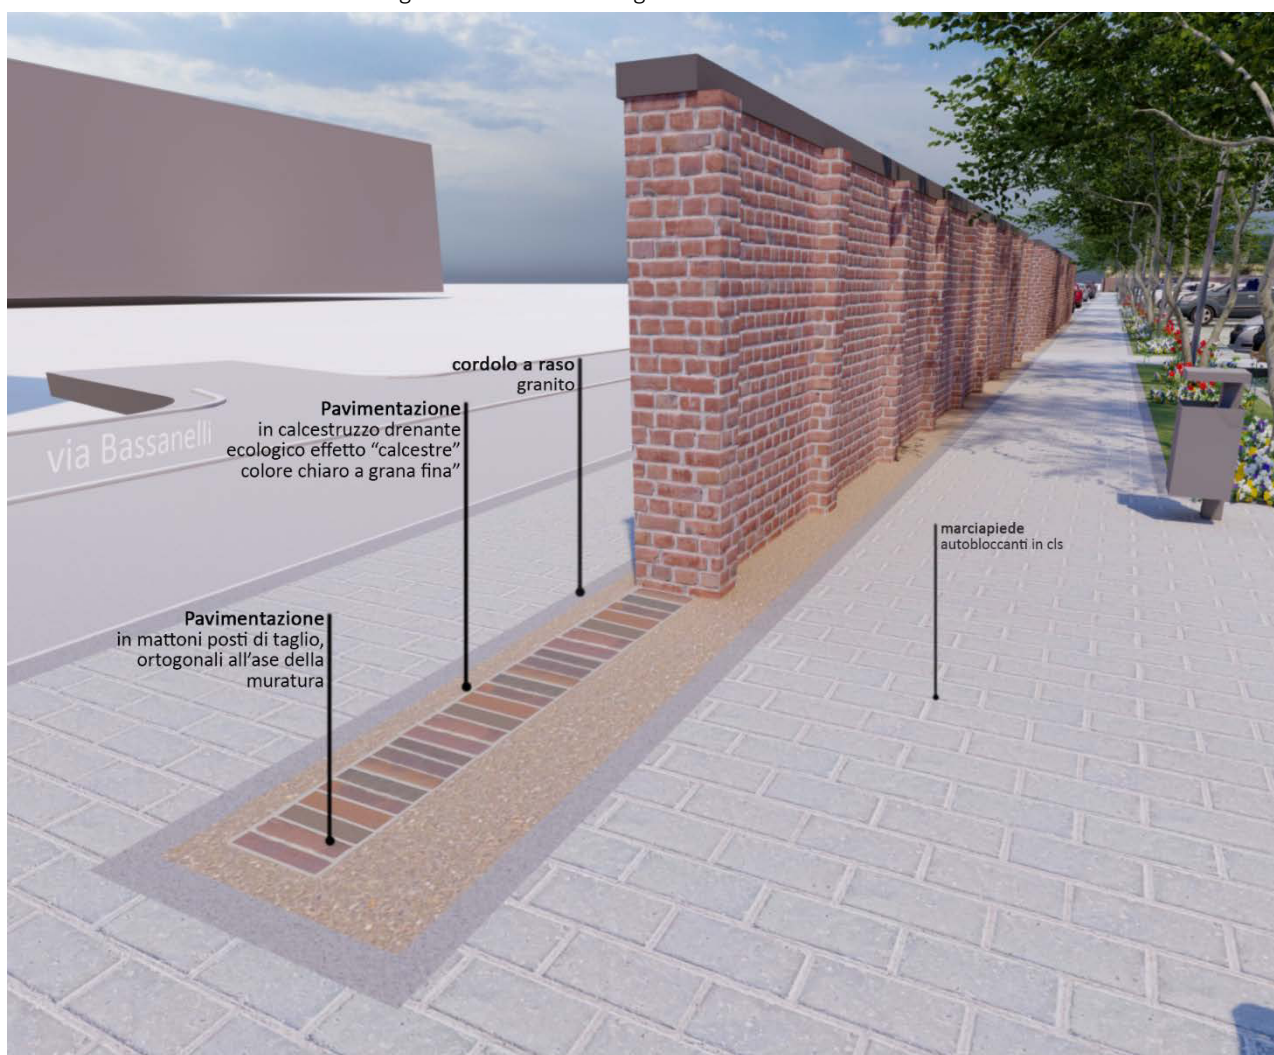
vista della muratura mantenuta - dettaglio finiture architettoniche
